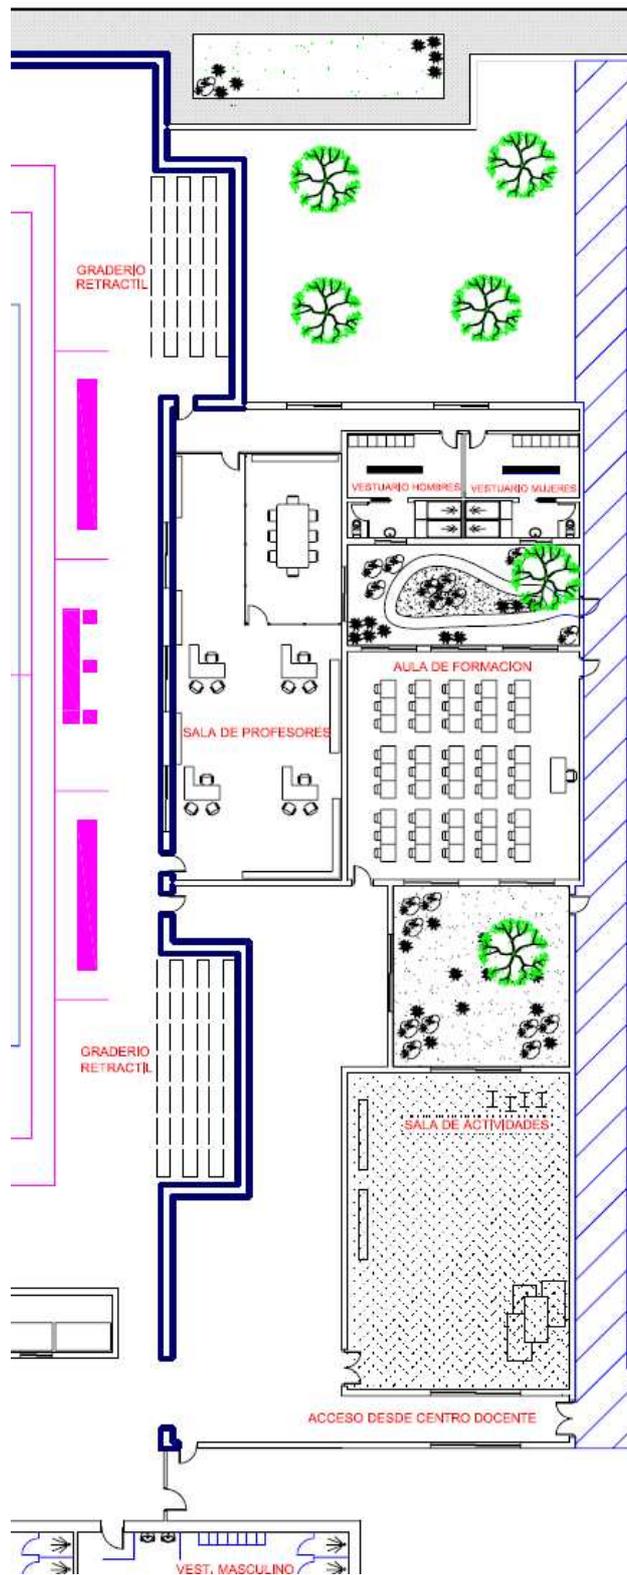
Propuesta de planta de ordenación general de instalación deportiva escolar
